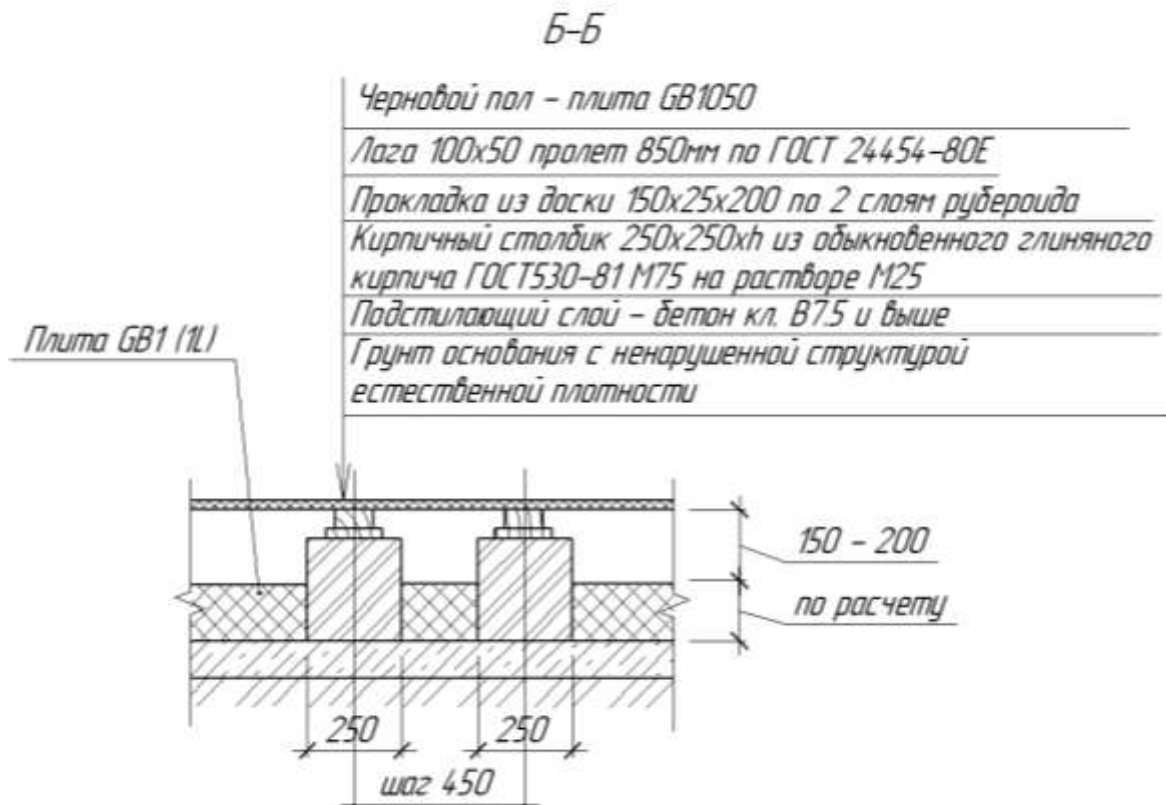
Раскладка утеплителя – плиты GB1 (GB1L) (разрез Б-Б)
